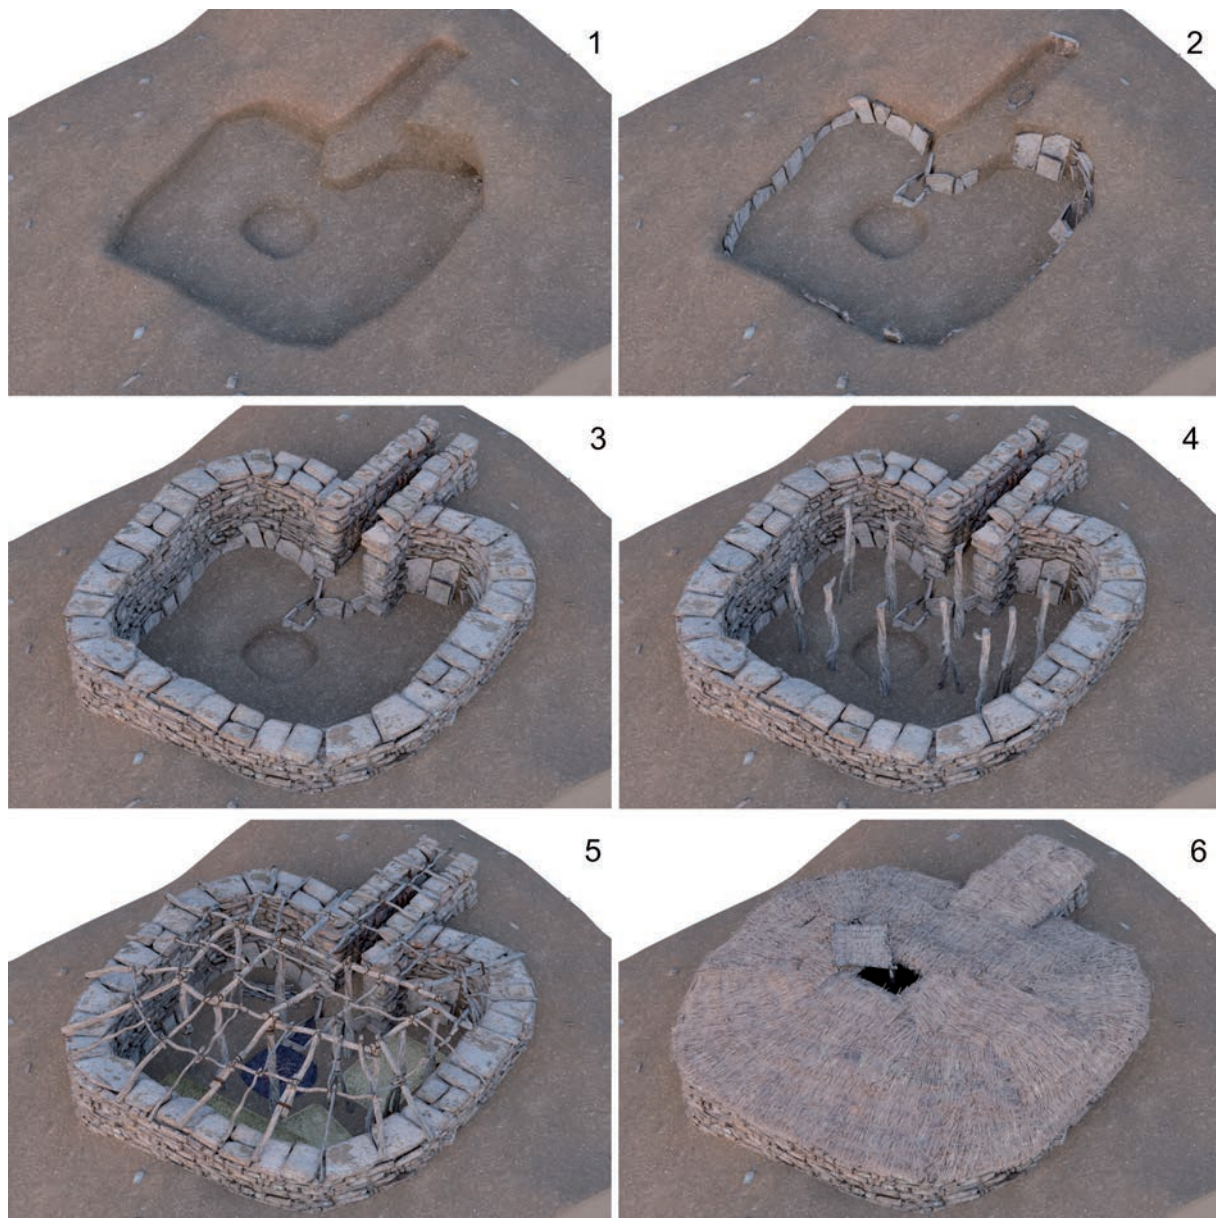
Поселение Токсанбай. Этапы возведения жилища № 2 (вид на юго-запад):
